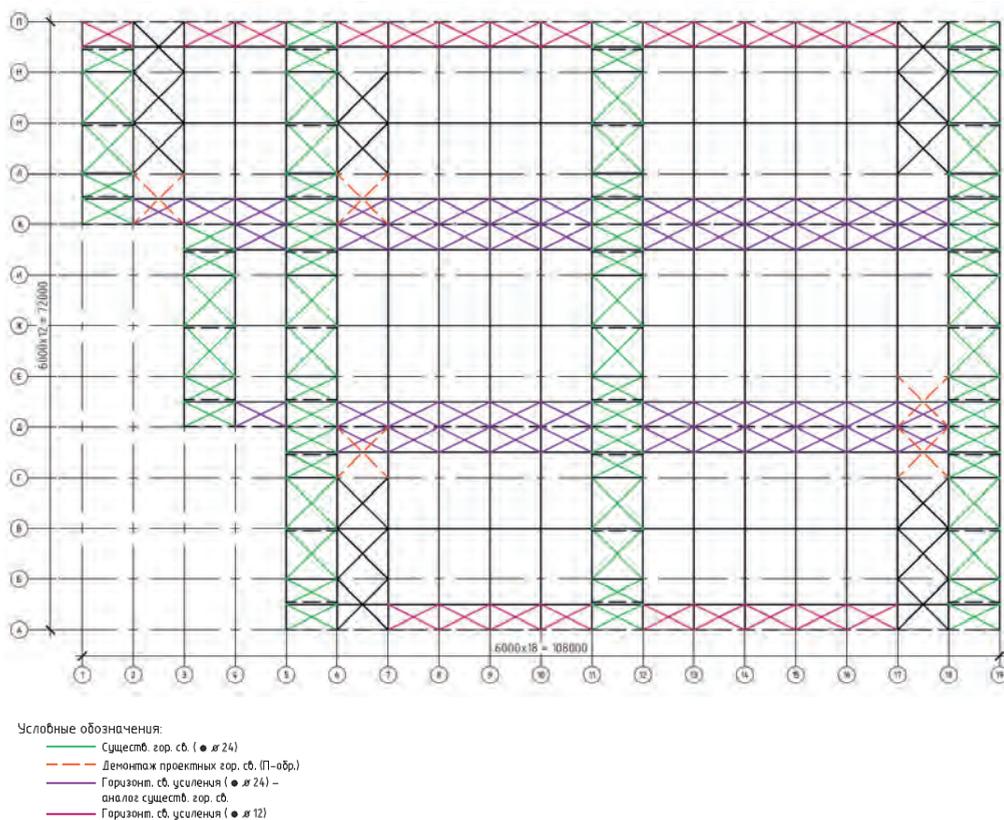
Рекомендации по установке дополнительных продольных горизонтальных связей по нижним поясам стропильных ферм здания склада
